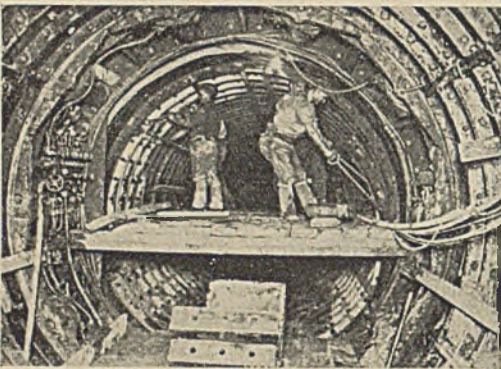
Umbau des Tunnels der C. & S. L. R.
